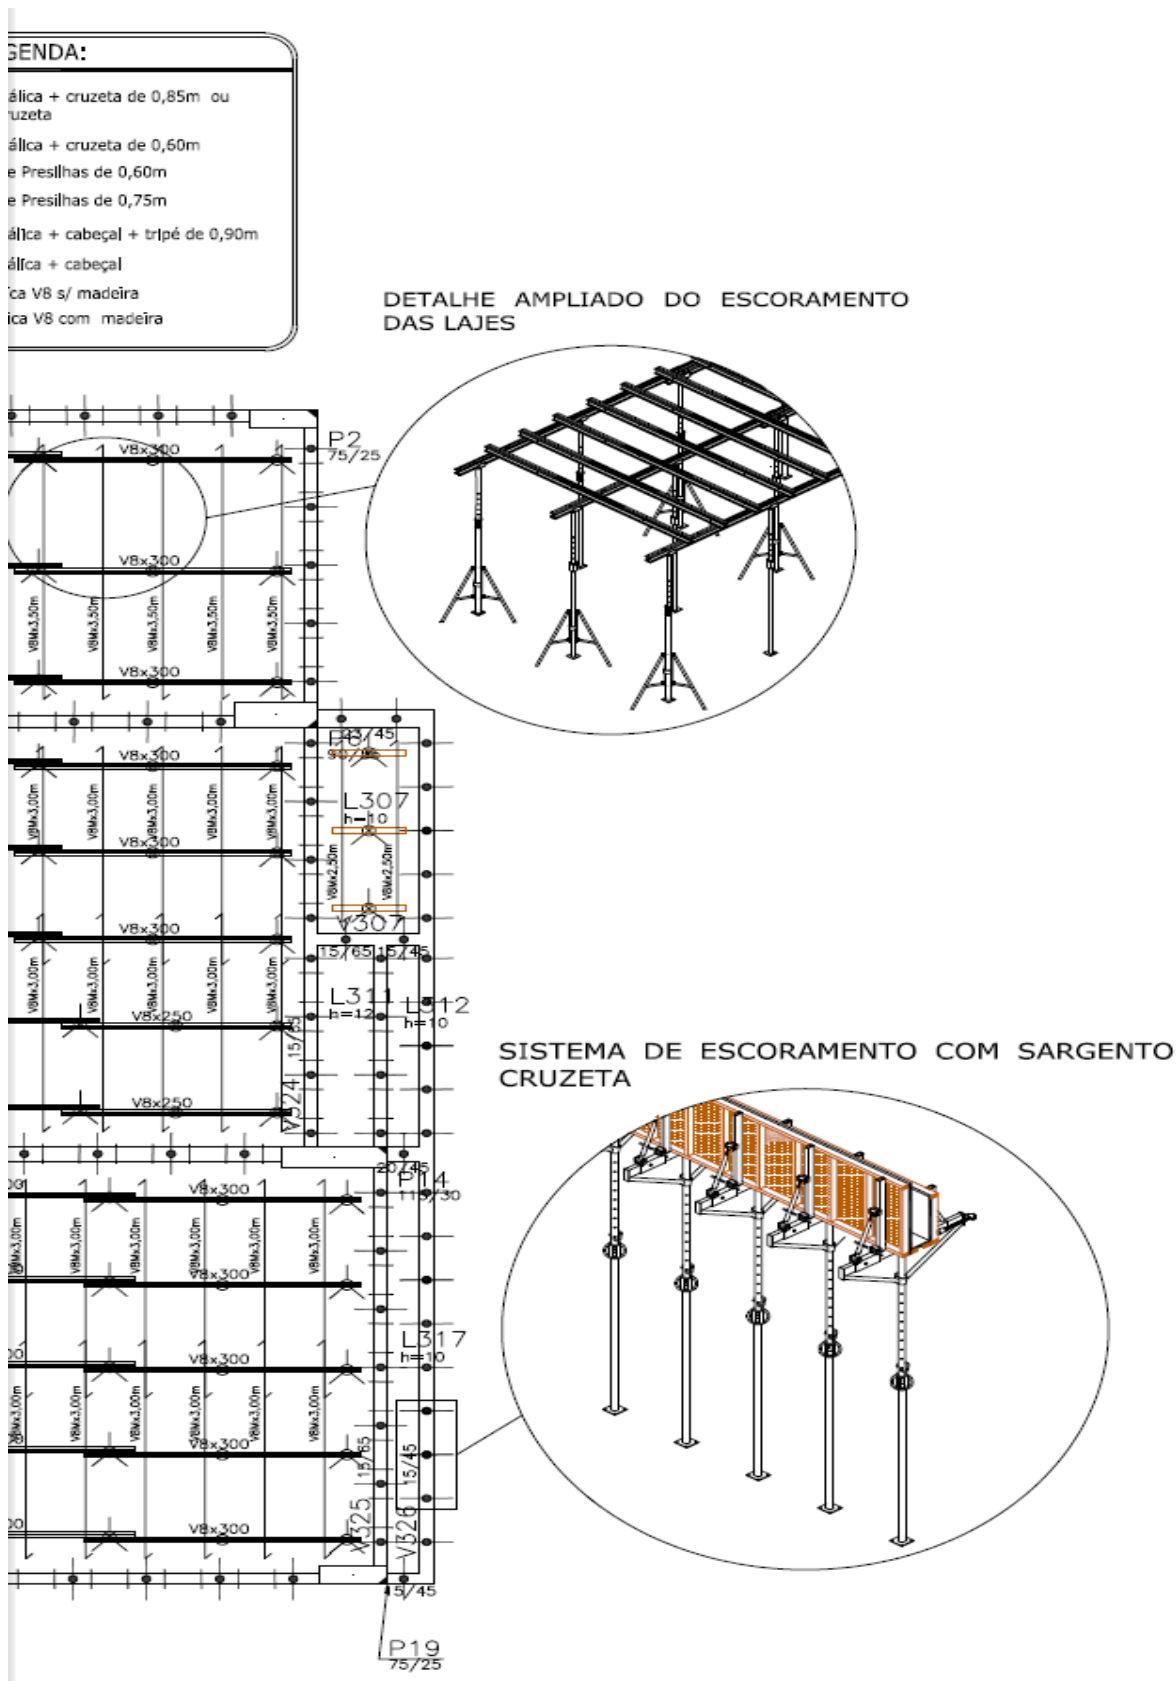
Edifício 1: Detalhe do escoramento das vigas internas, distribuidas a cada 0,80m
